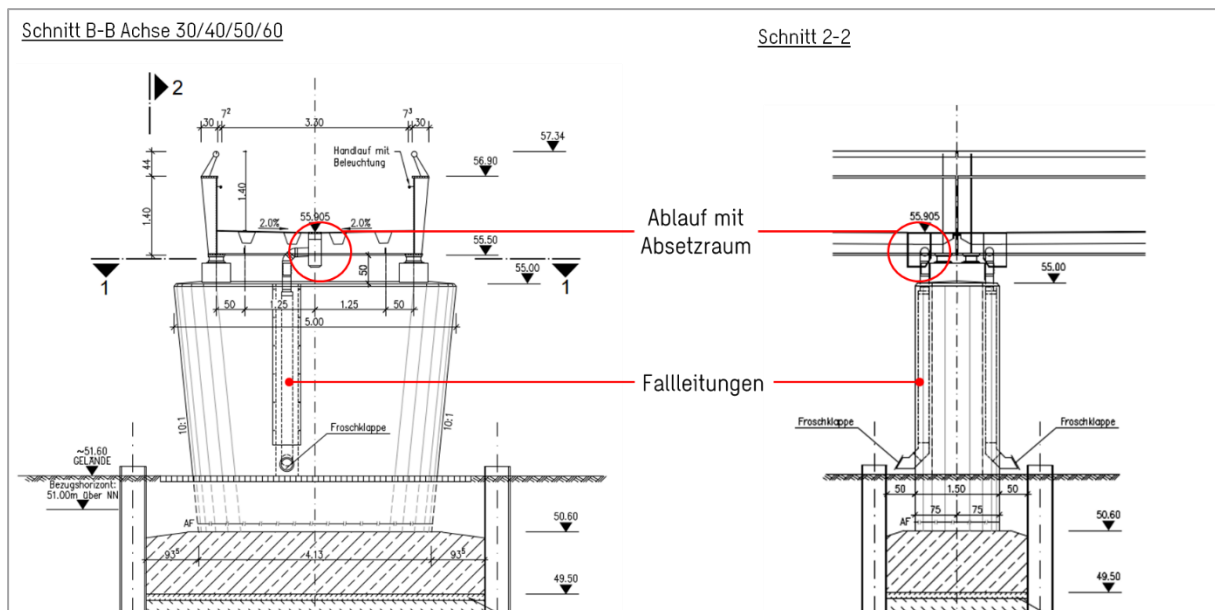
Prinzipskizze Versickerung Auenvorland: Achse 30/40/50/60 Brückenpfeiler mit Fallrohr und Froschklaappe, angepasst aus Bauwerksplan Brücke: Schnitte und Details [8]
